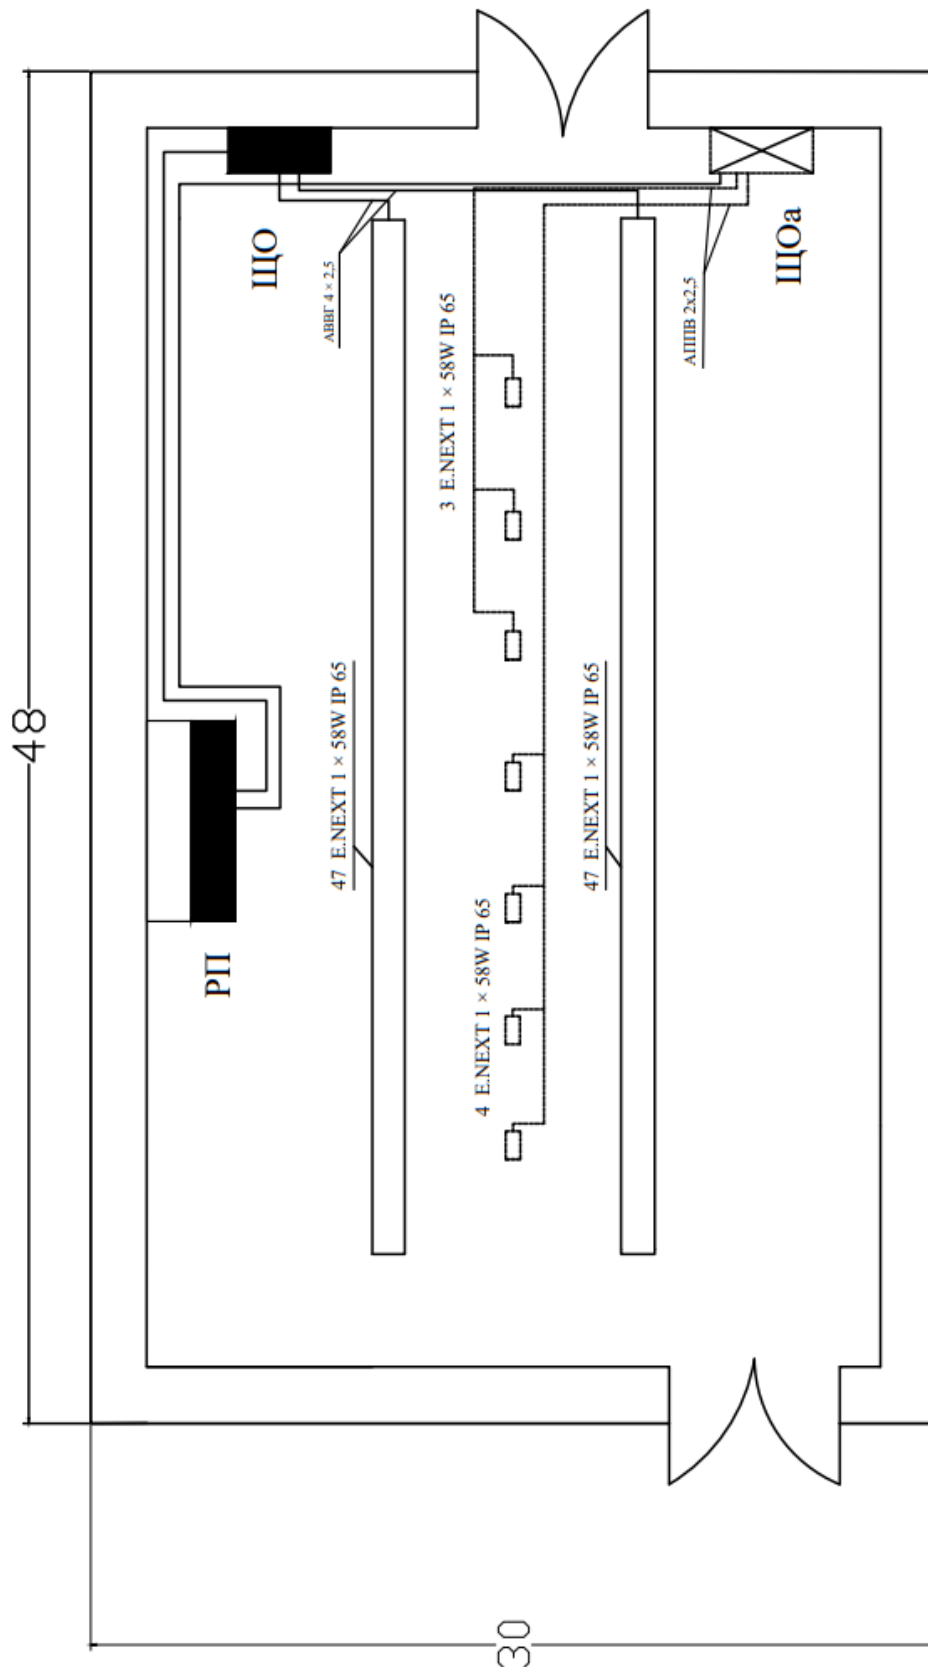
Схема робочого та аварійного освітлення інструментального цеху
